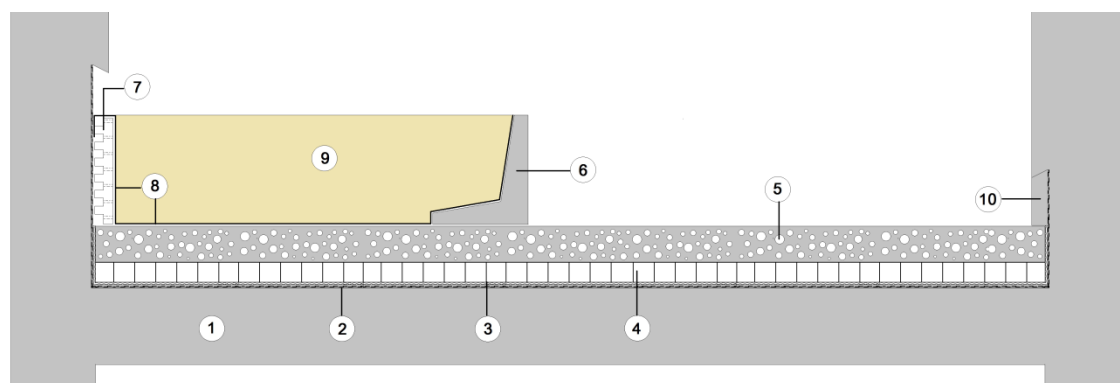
Joint de dilatation pour toitures-terrasses accessibles piétons ou véhicules
